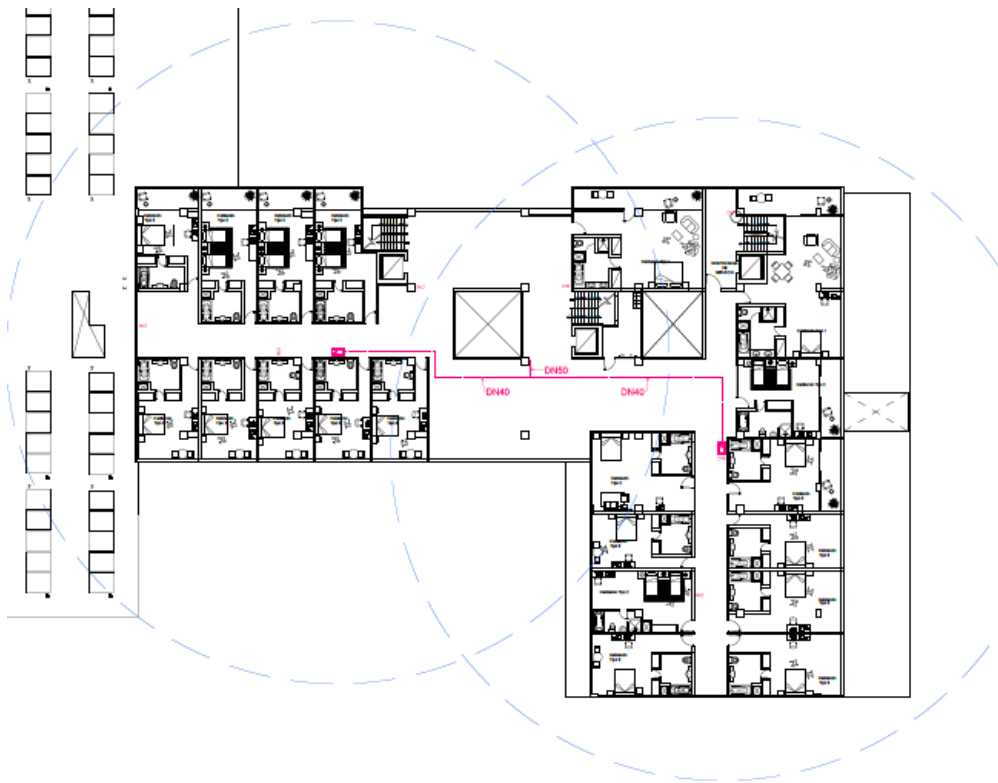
Ubicación BIEs y alcances. Plantas 2ª hasta 6ª. Planos del proyecto
